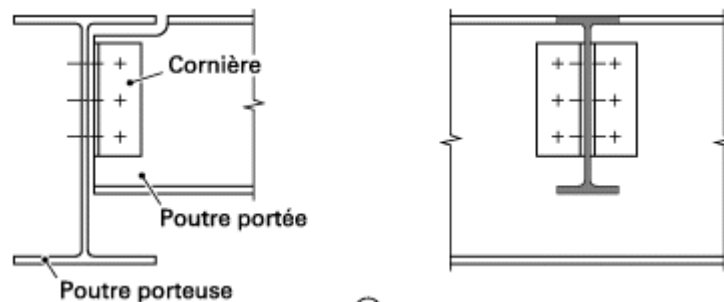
exemple d'assemblage poutre solive avec des cornières.
